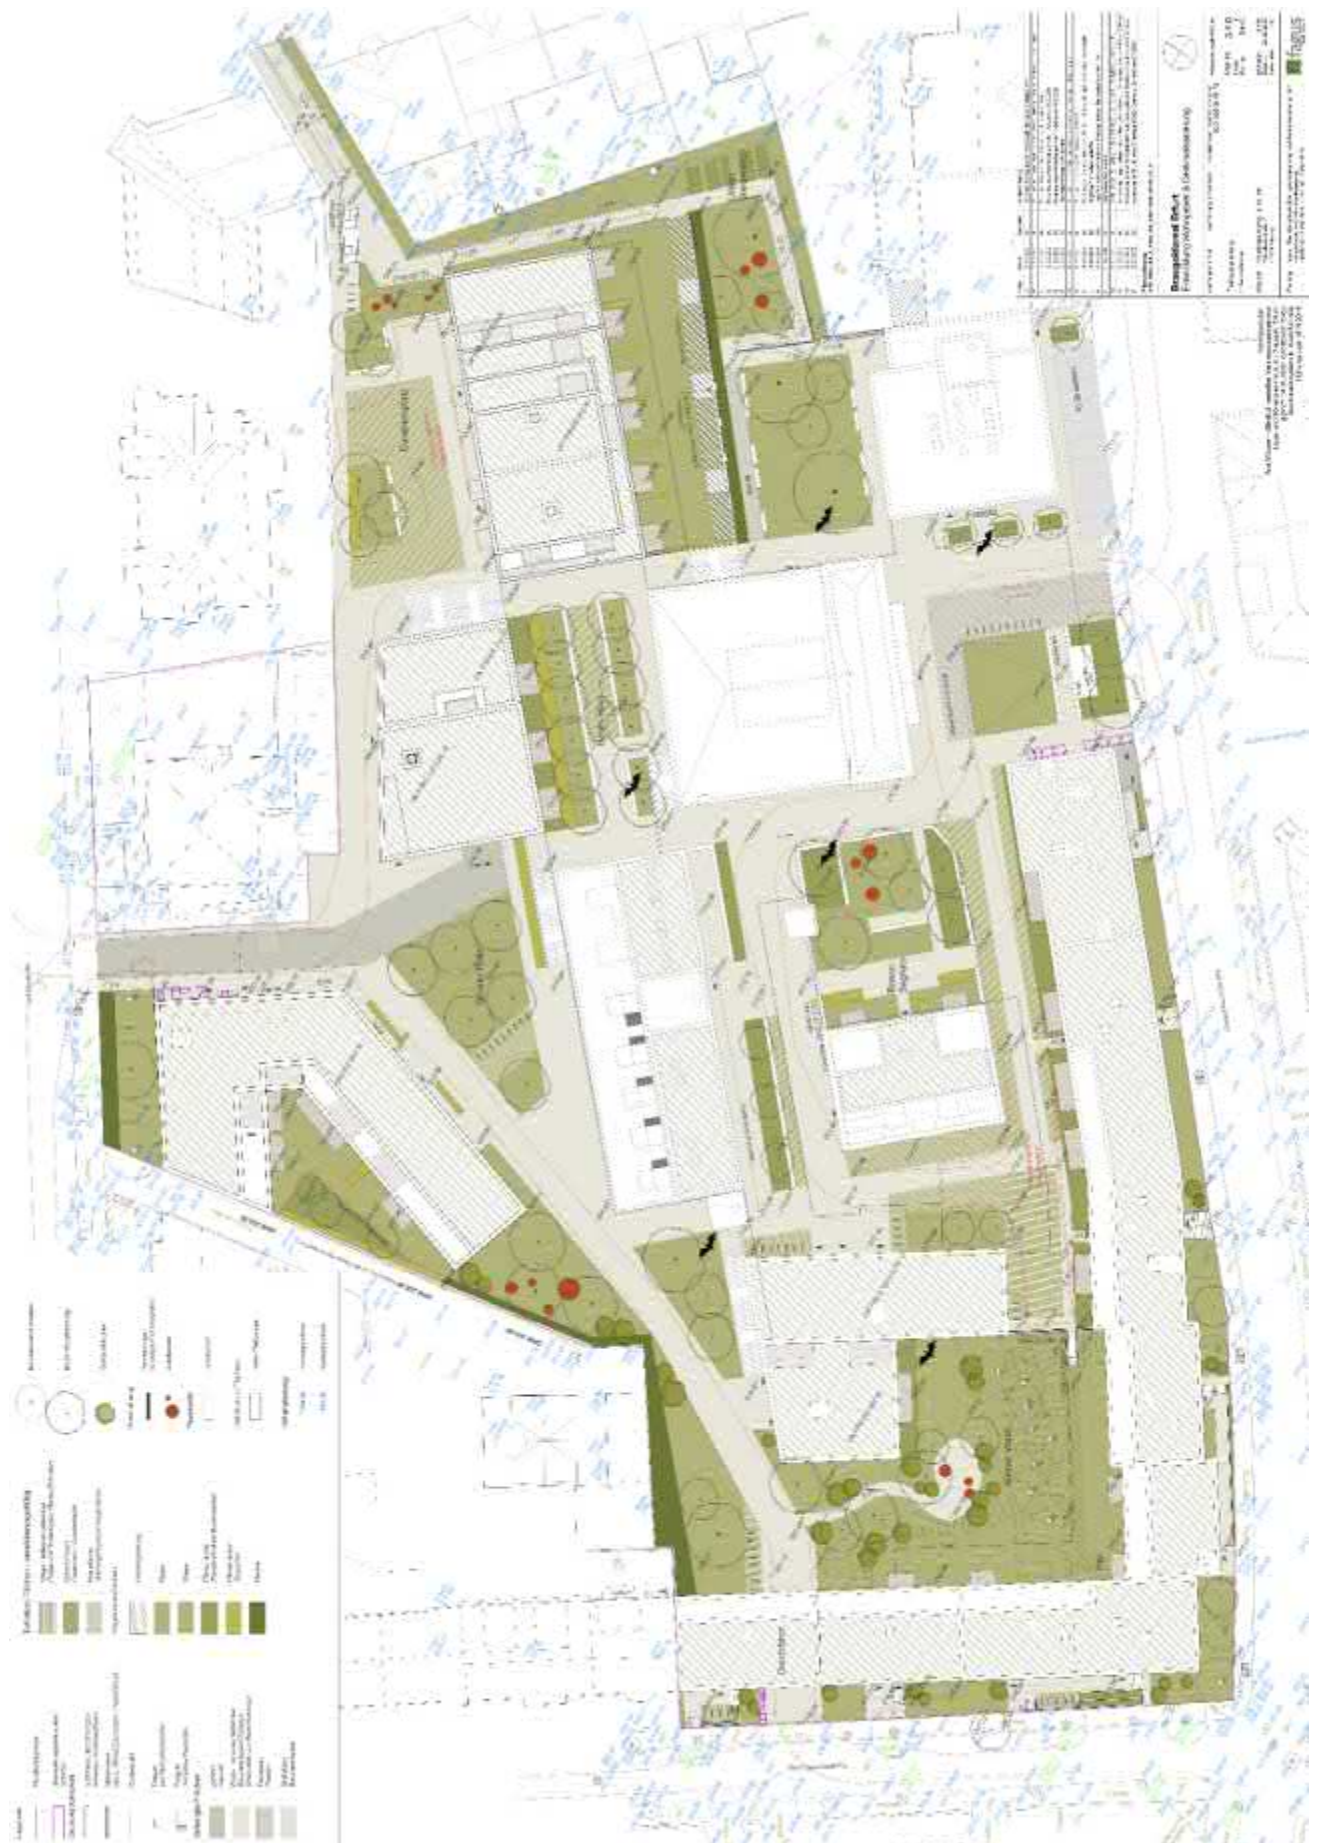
Entwurf Freianlagenplan zum VE-Plan
